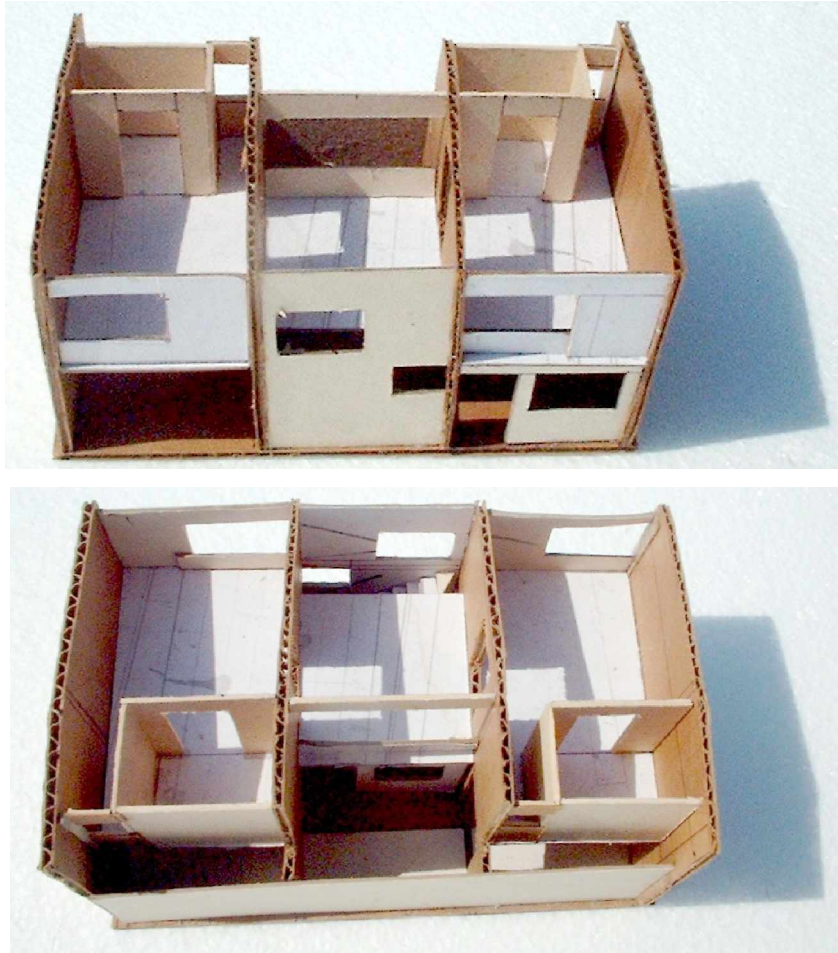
MAQUETA DE TRABAJO DE TRES ESPACIOS FACHADA
